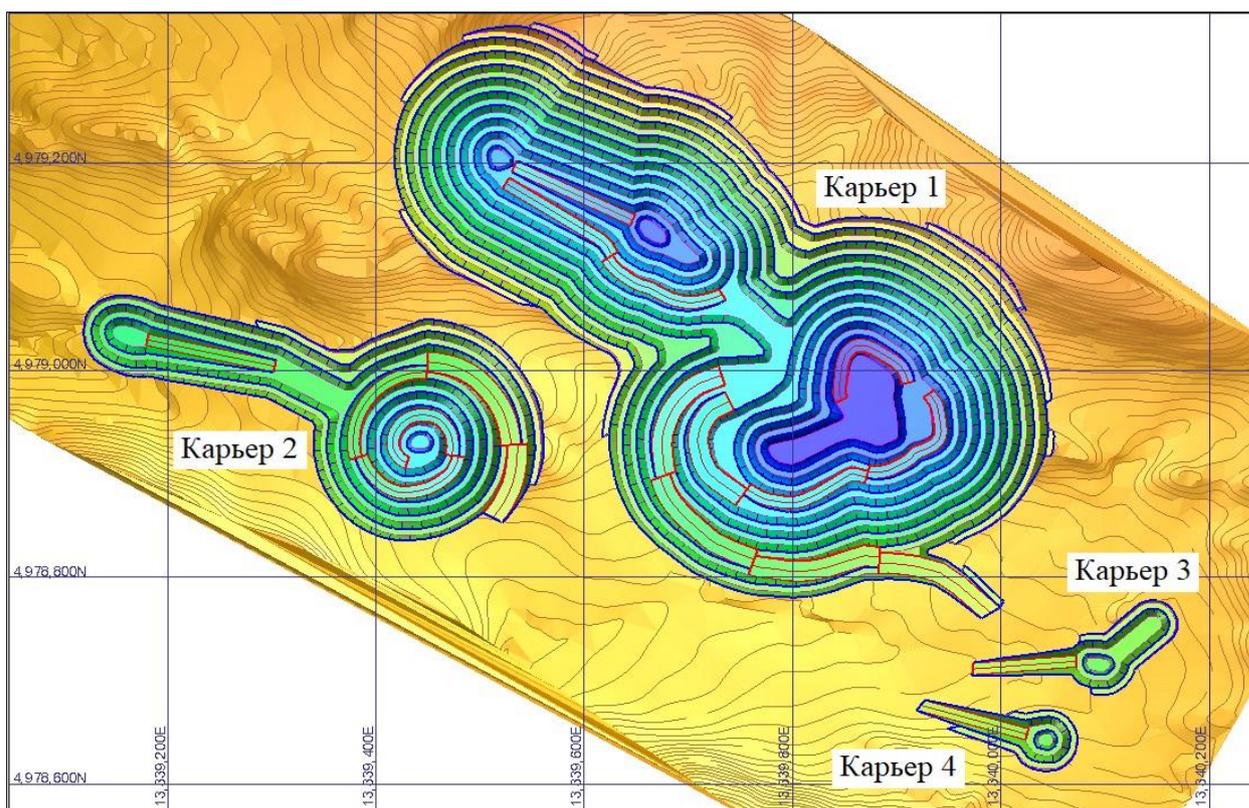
План Карьеров № 1-4 на конец отработки
